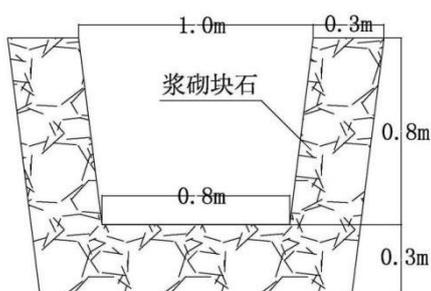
采场截排水沟断面示意图 图 5-2 矿山道路截水沟断面示意图
